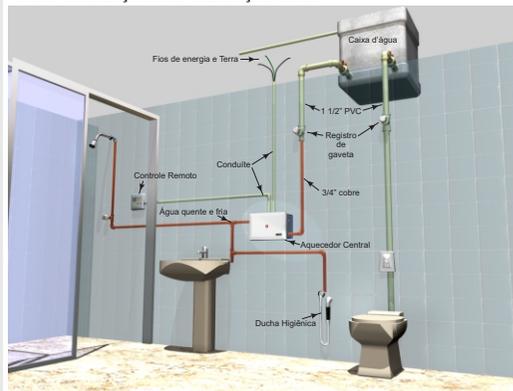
INSTALAÇÃO COM DUAS TUBULAÇÕES
